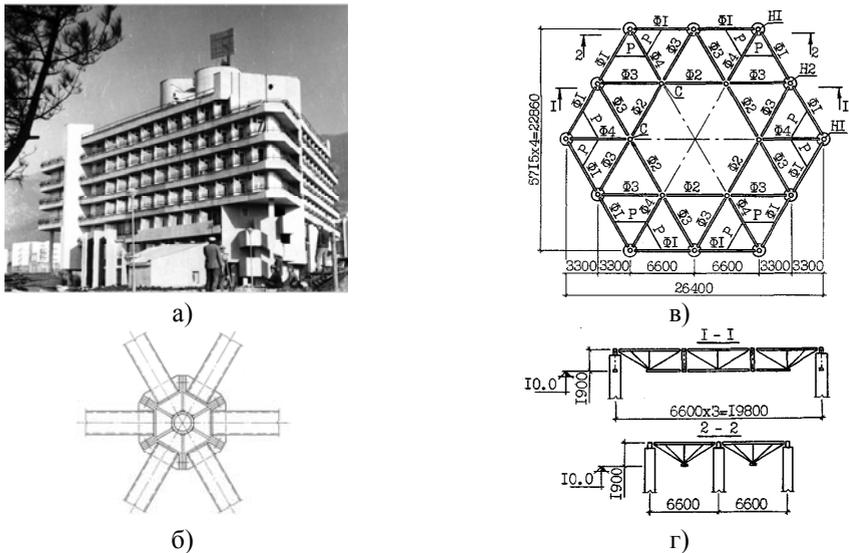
Санаторно-кардиологический комплекс в Арзни: а – снимок общего вида; б – схема узлового соединения перекрестных ферм и стойки их решеток; в, г – план, разрезы каркаса покрытия
